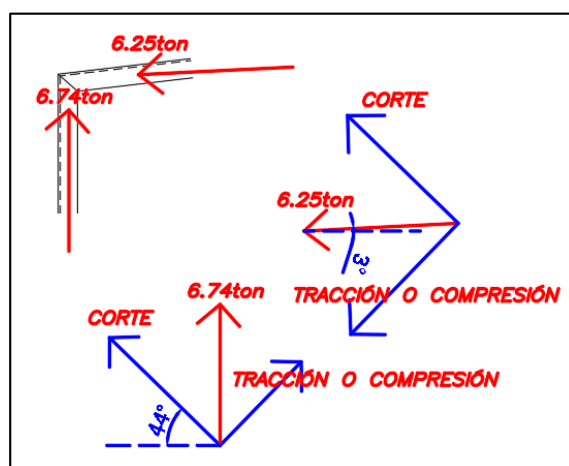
CARGAS REQUERIDAS EN UNIÓN BRIDA SUPERIOR Y MONTANTE
